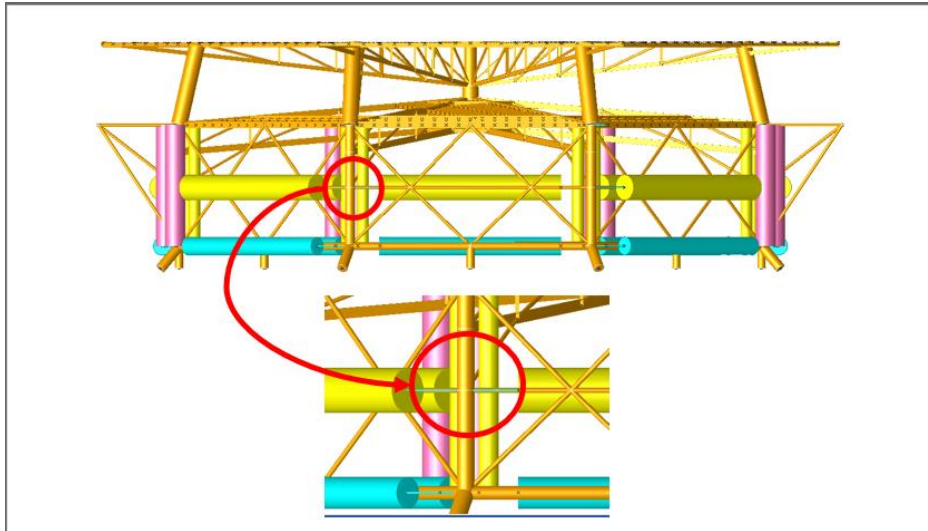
Joint Pada *Buoyancy Frame* Bagian Atas (*K Brace*)
